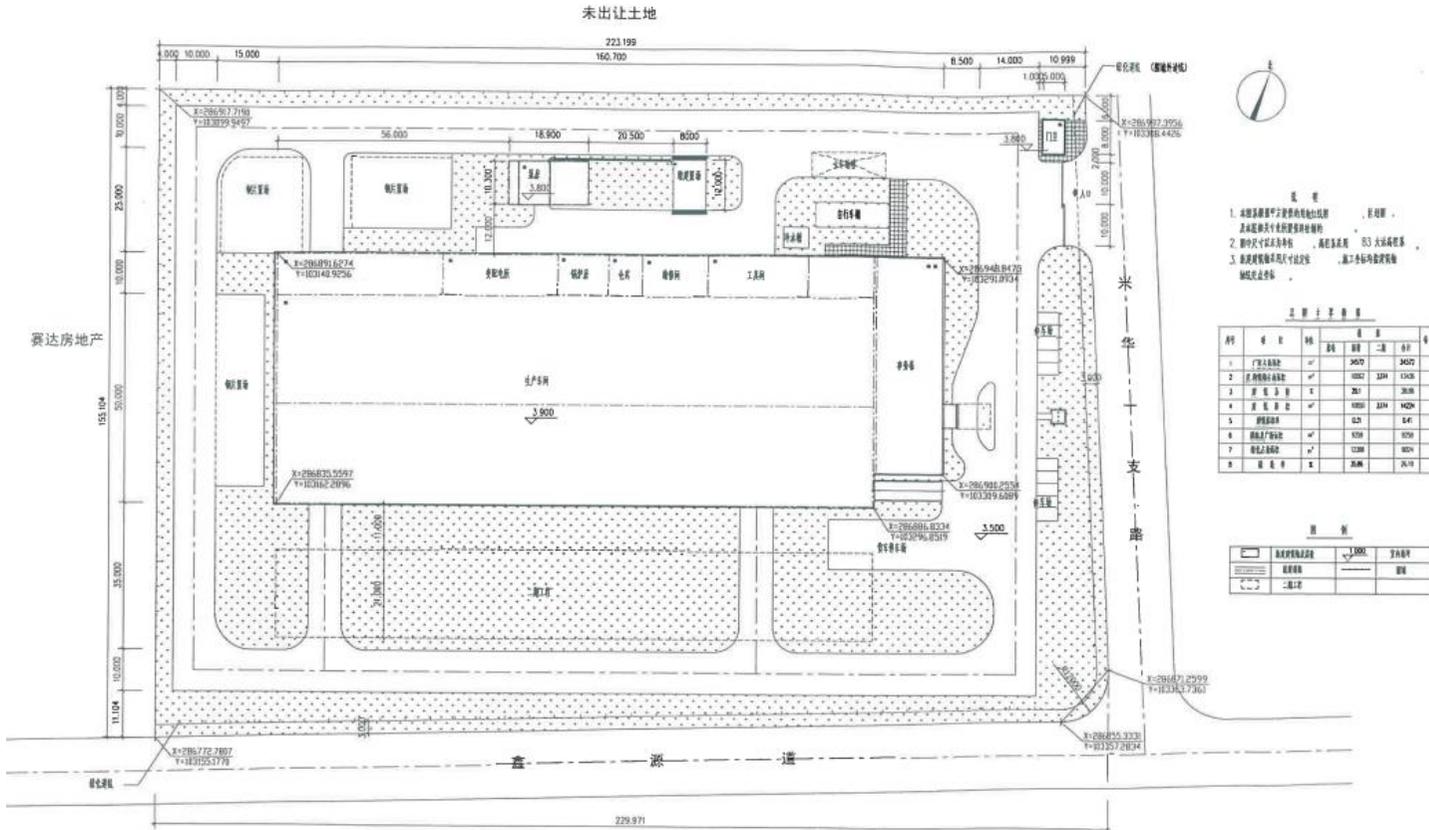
戴卡优艾希杰渤铝（天津）精密铝业有限公司厂区平面图
